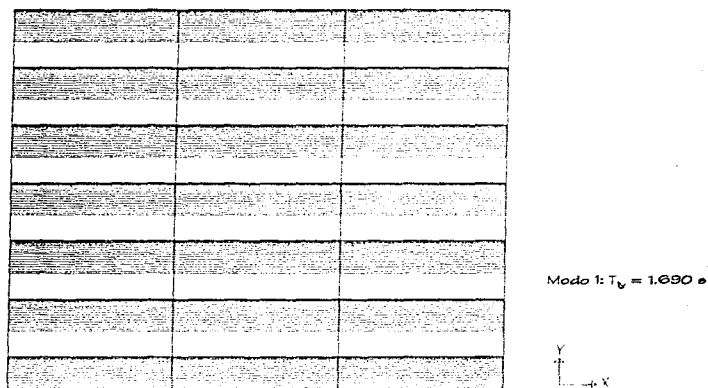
Vista en planta del modo fundamental de vibración en la dirección "Y", estructura de 17 niveles diseñada en la zona II
